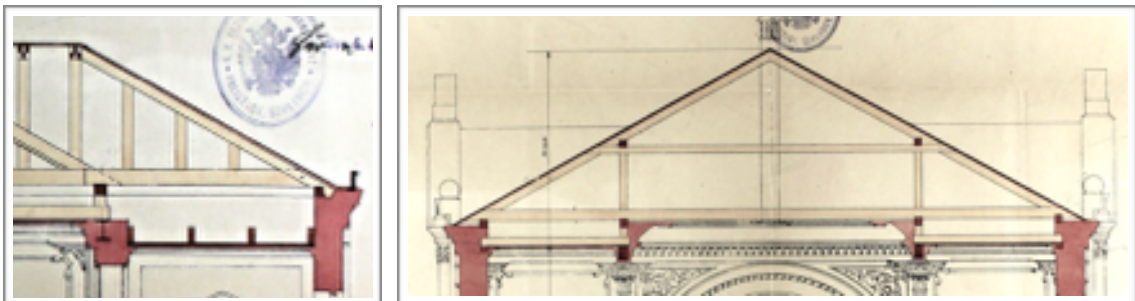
und 78: Ausschnitte Dachkonstruktion - Pfettendach mit Walm und Seitengiebeln
